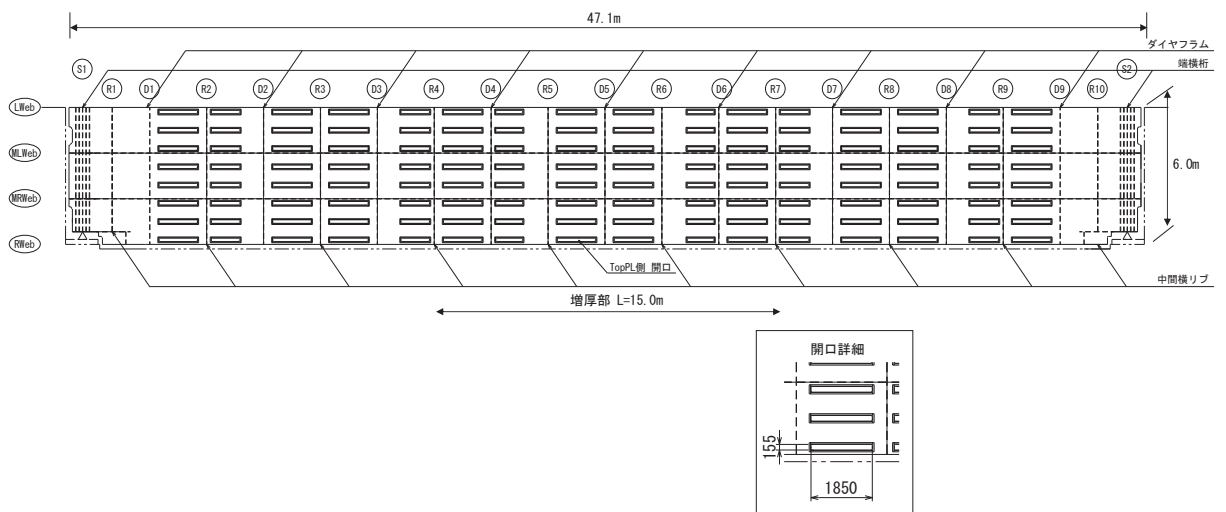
(2) 鋼製遮水壁（鋼桁 4） 平面図
